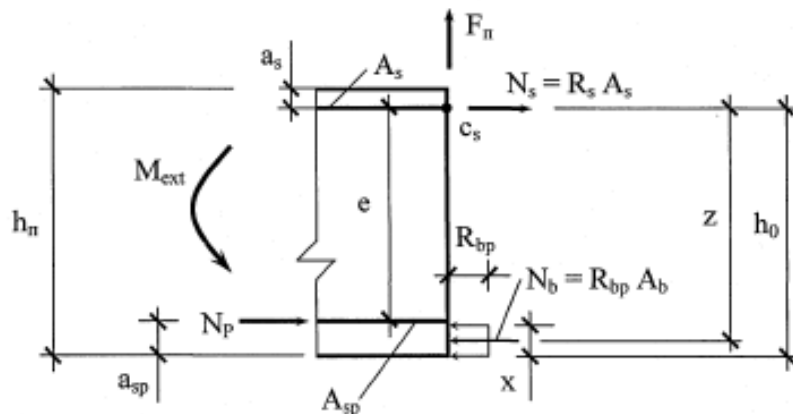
Схема внешних и внутренних усилий в расчётном сечении.
